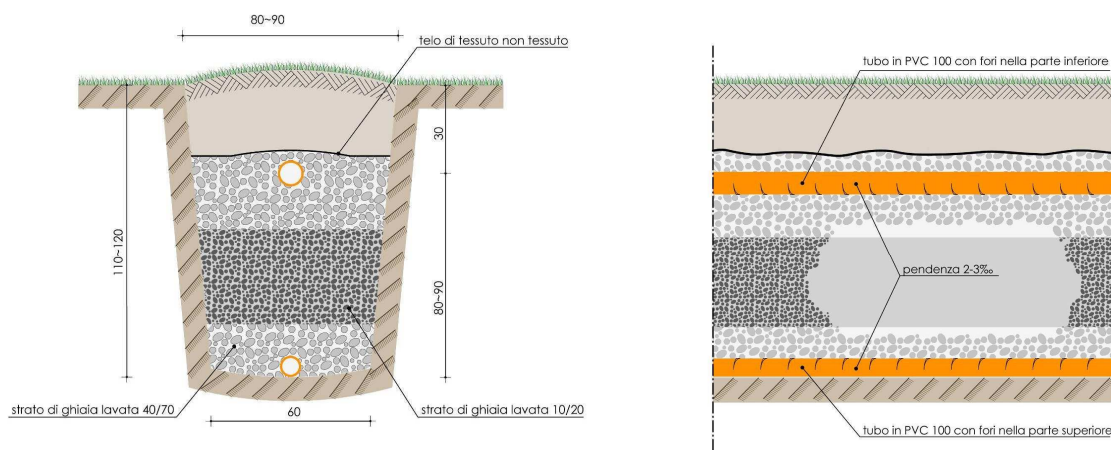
Sezione verticale trasversale e longitudinale di una trincea di un sistema di subdispersione con drenaggio.
